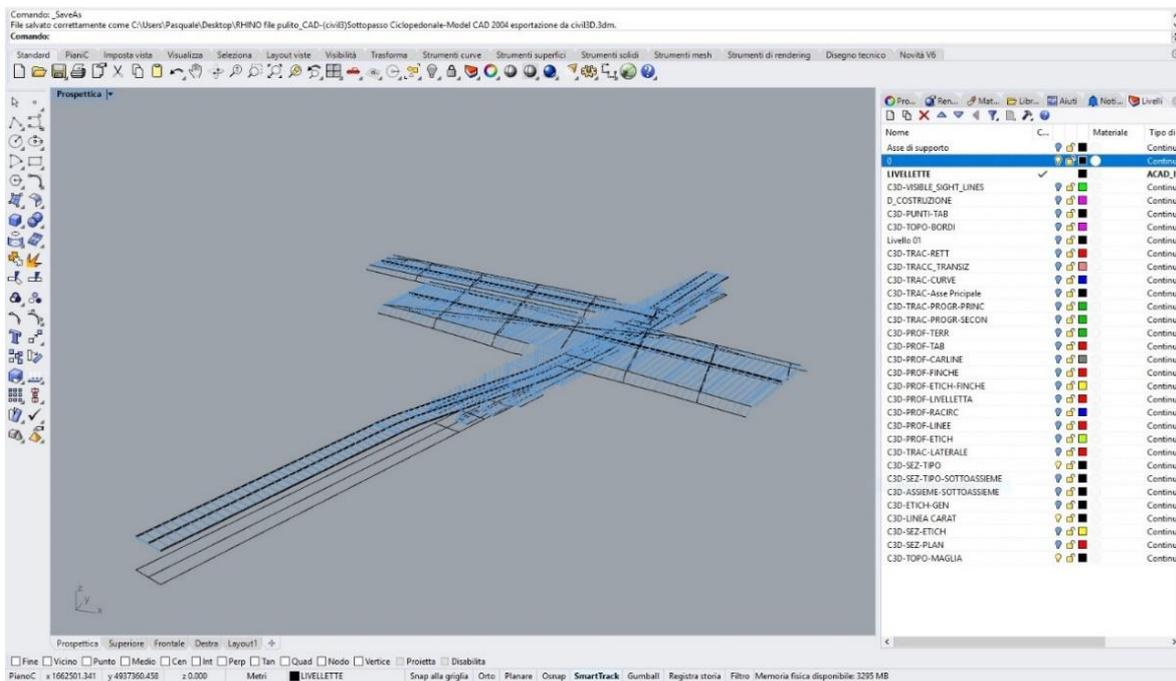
Dettaglio della geometria strutturale del sottopasso ciclopedonale
